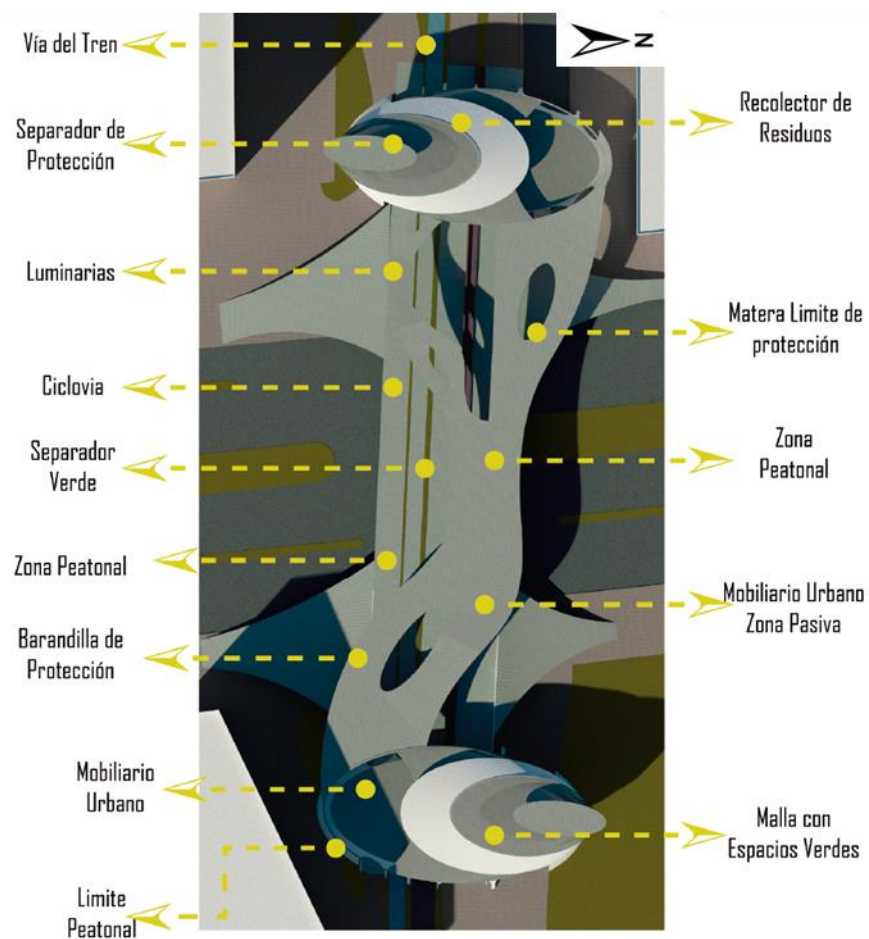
Vista en planta propuesta arquitectónica. Elaboración propia, (Ilustrador).
